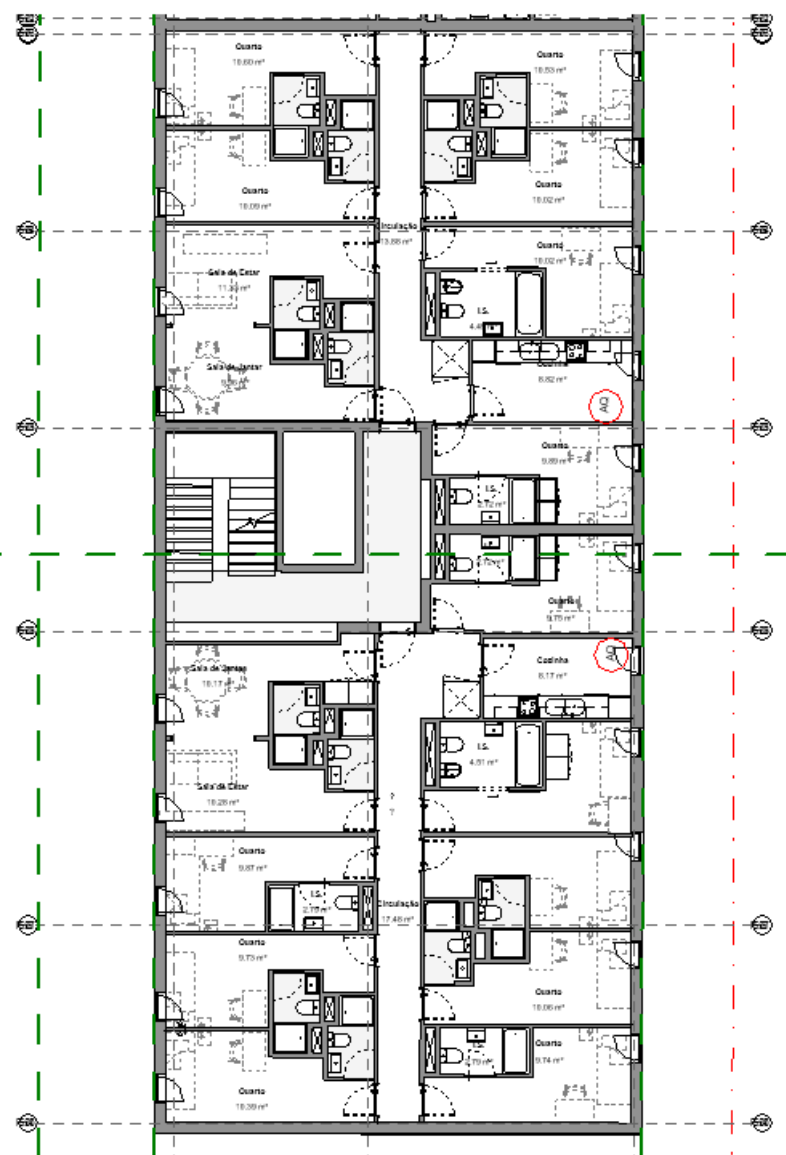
Planta de arquitetura – Piso 4 ao 7 (Revit)
